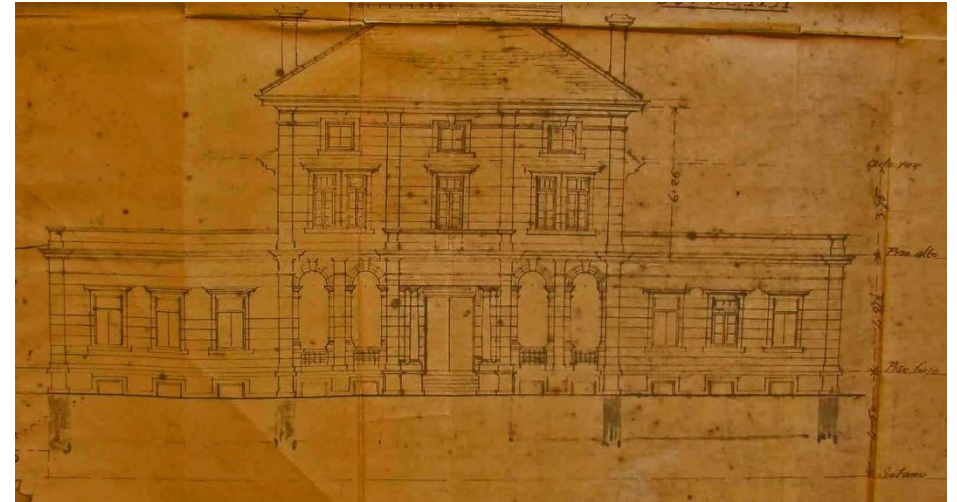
Fachada sudeste, 16-05-1918, Prancha n.49. Acervo: Clube Campestre.
